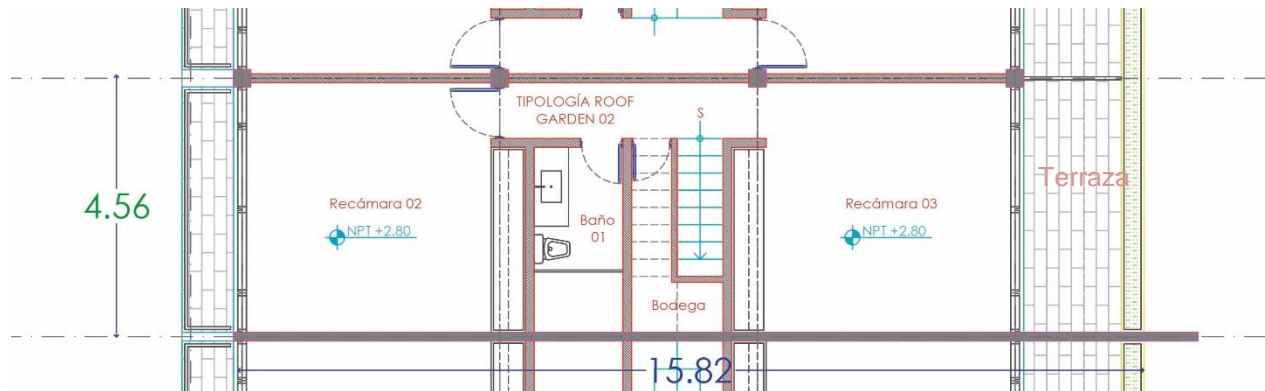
Se muestran los compartimentos de la Villa Roof Garden tipo 2 en planta baja.
